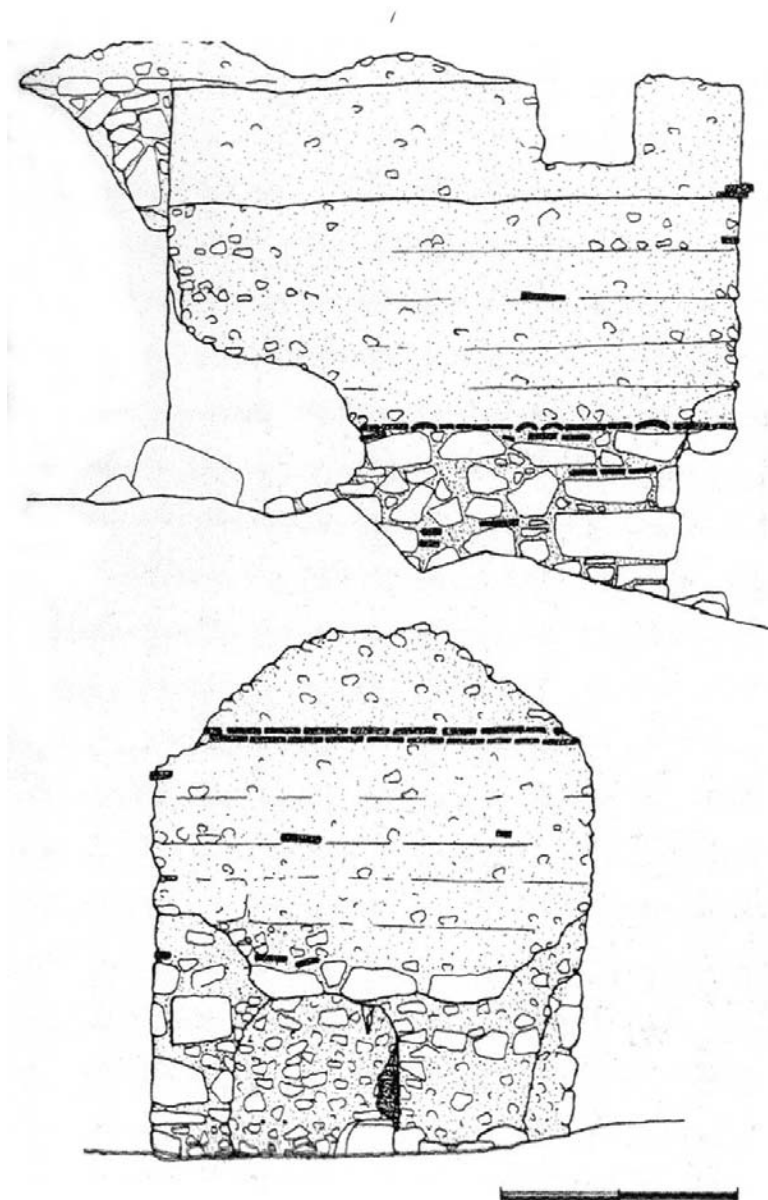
Perfil y planta del *castellum aquae* de la conducción de Segovia
